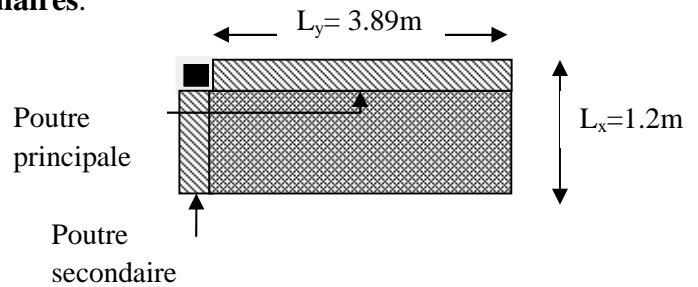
schéma de la dalle plein sur 2appuis.
